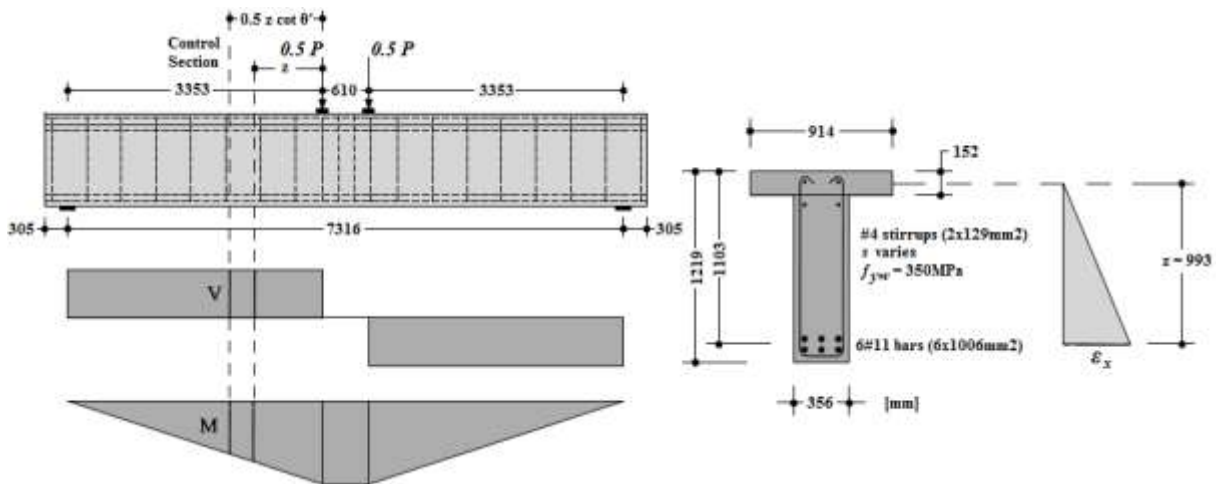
Geometria e armaduras de corte e flexão das vigas testadas por Higgins et al. (dimensões em mm) [23].
